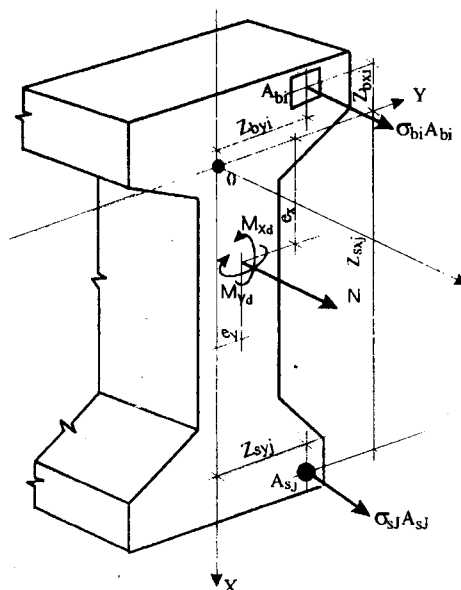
Расчетная схема нормального сечения железобетонного элемента
